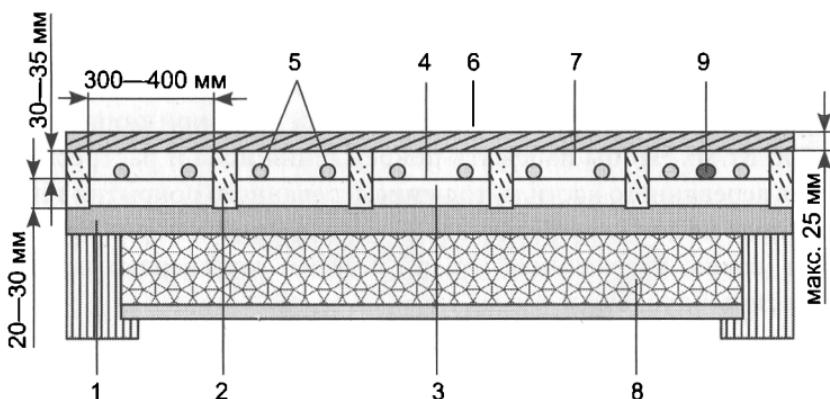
Монтаж теплого пола по деревянным перекрытиям:
